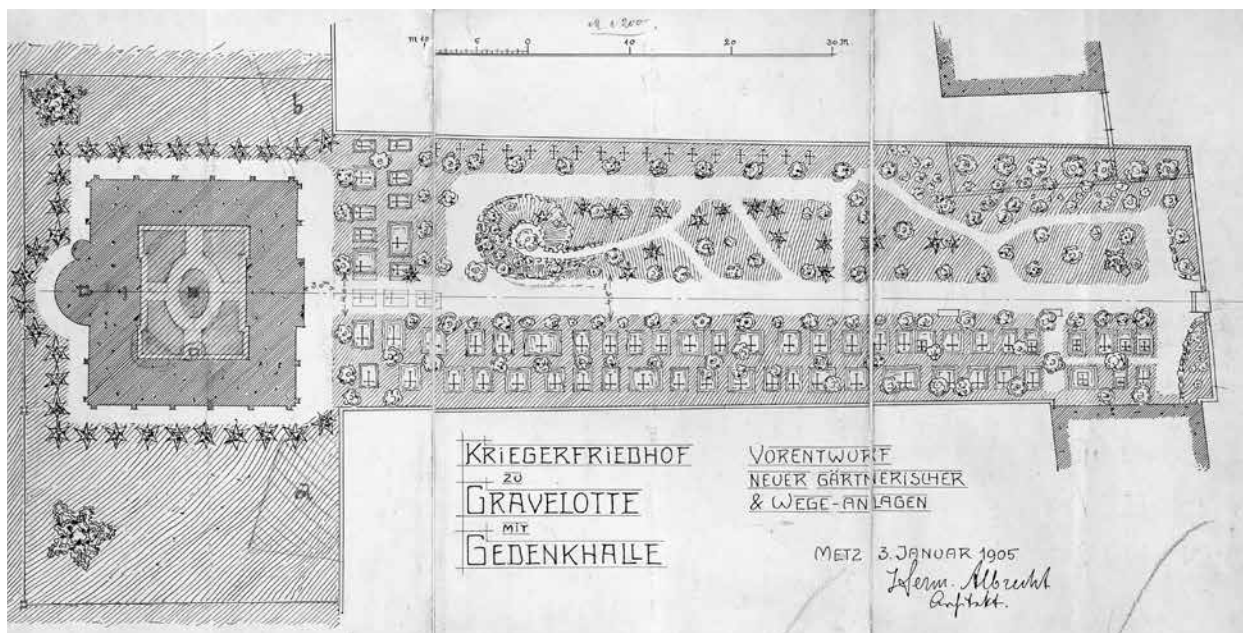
Plan d'aménagement de la Halle du Souvenir et du cimetière, 1905 (Arch. départ. Mos. 6 AL 346).
